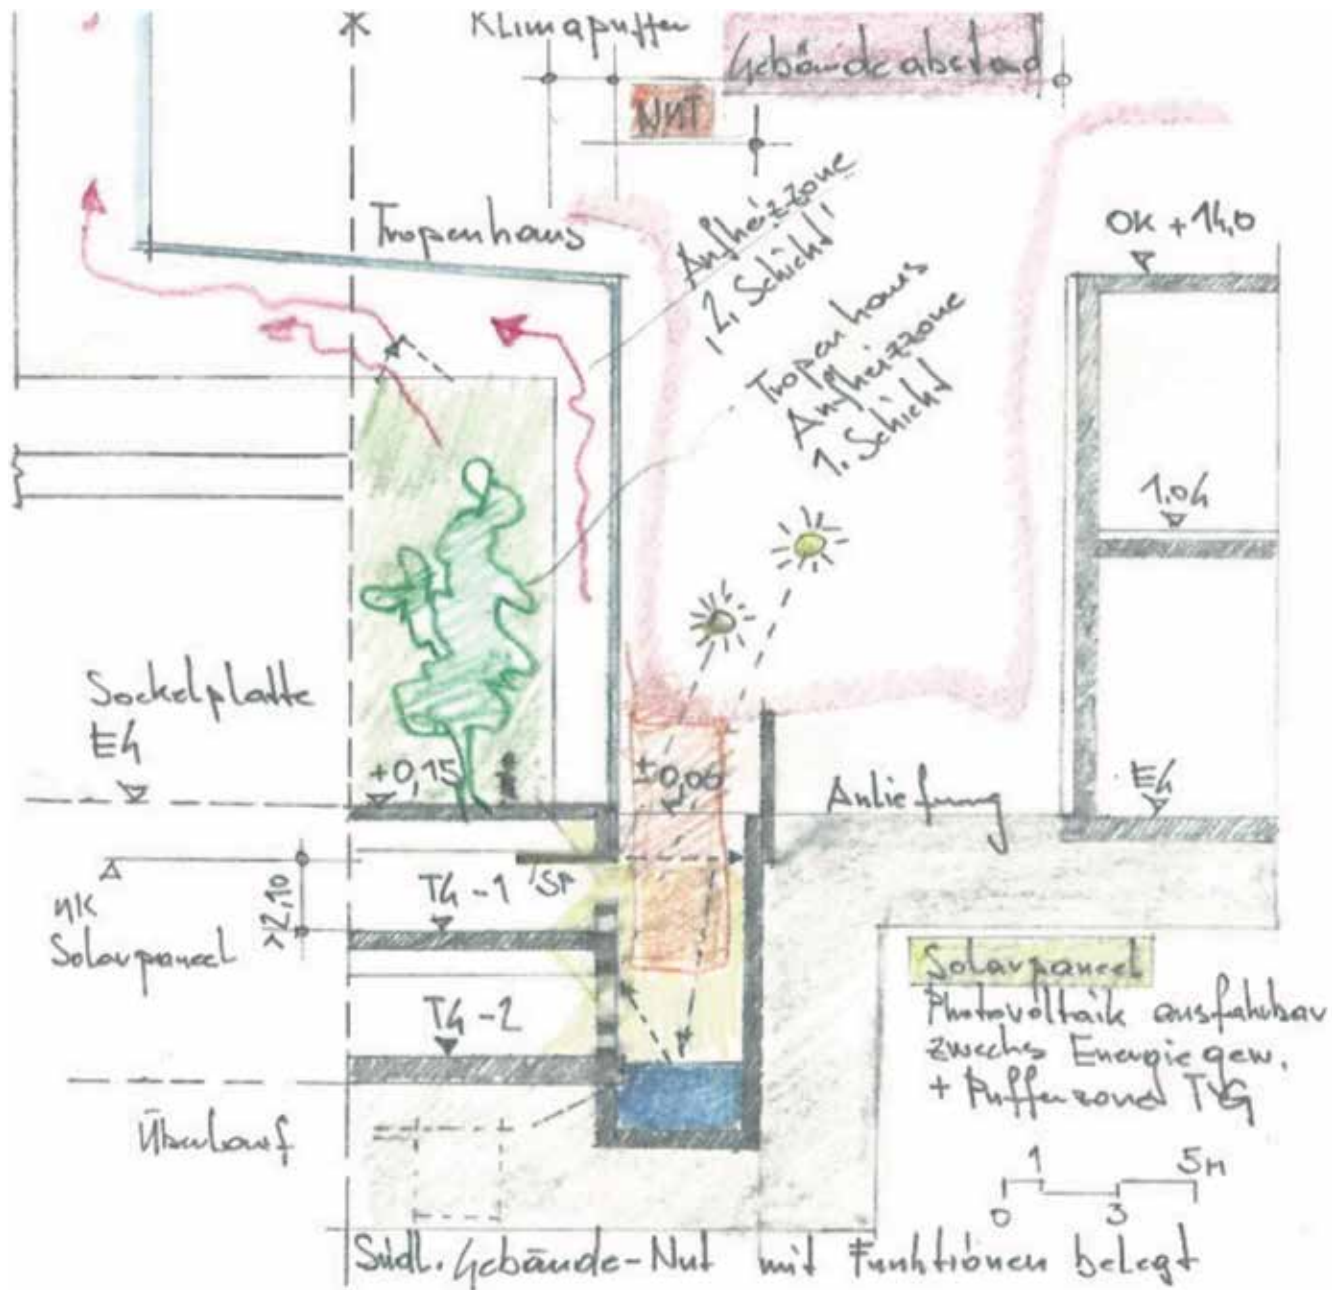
Schnitt: Untergeschoße - Tropenhaus: Belichtung, Wassergraben
